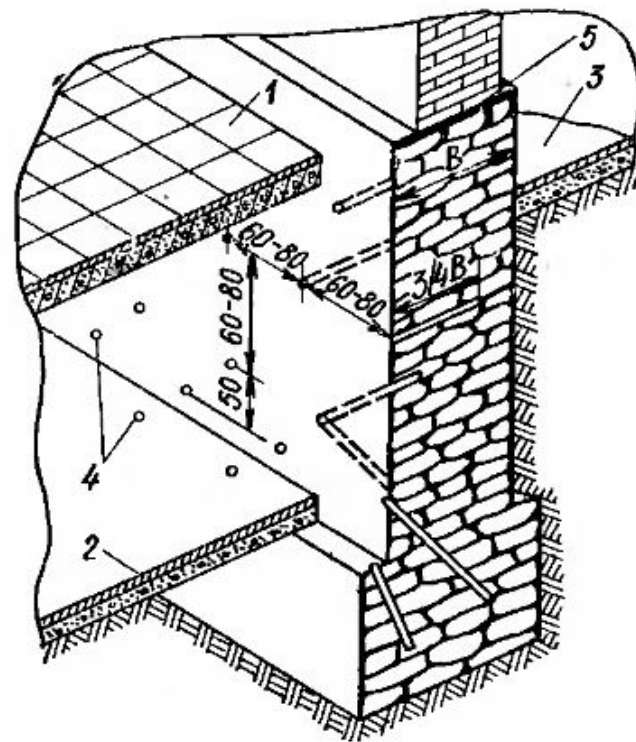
Схема расположения отверстий для инъекции при химическом методе укрепления кладки фундамента
